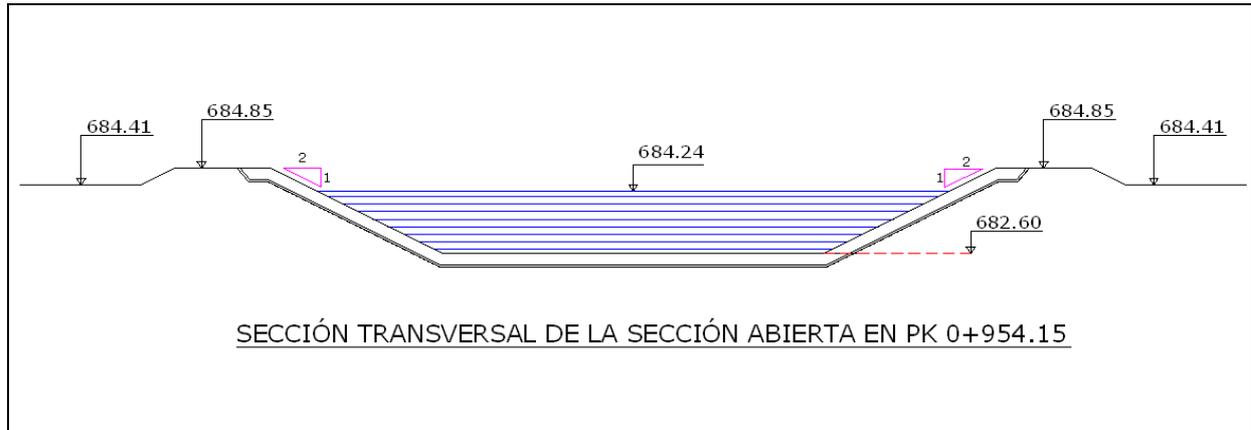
Sección transversal de la sección abierta del Marco Principal en PK 0+954.15
